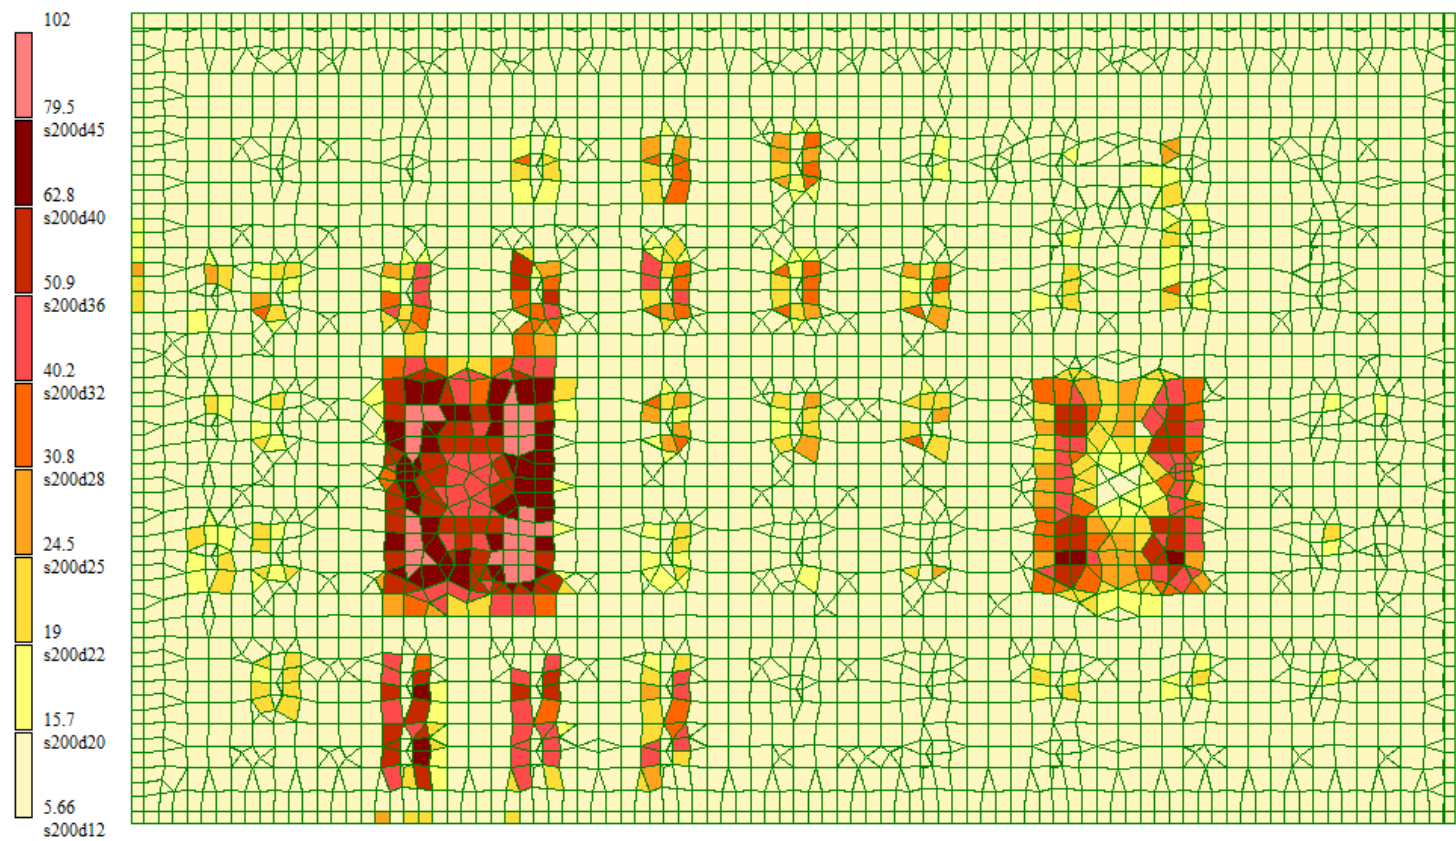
Схема армирования верха фундаментной плиты по оси OX и по оси OY
